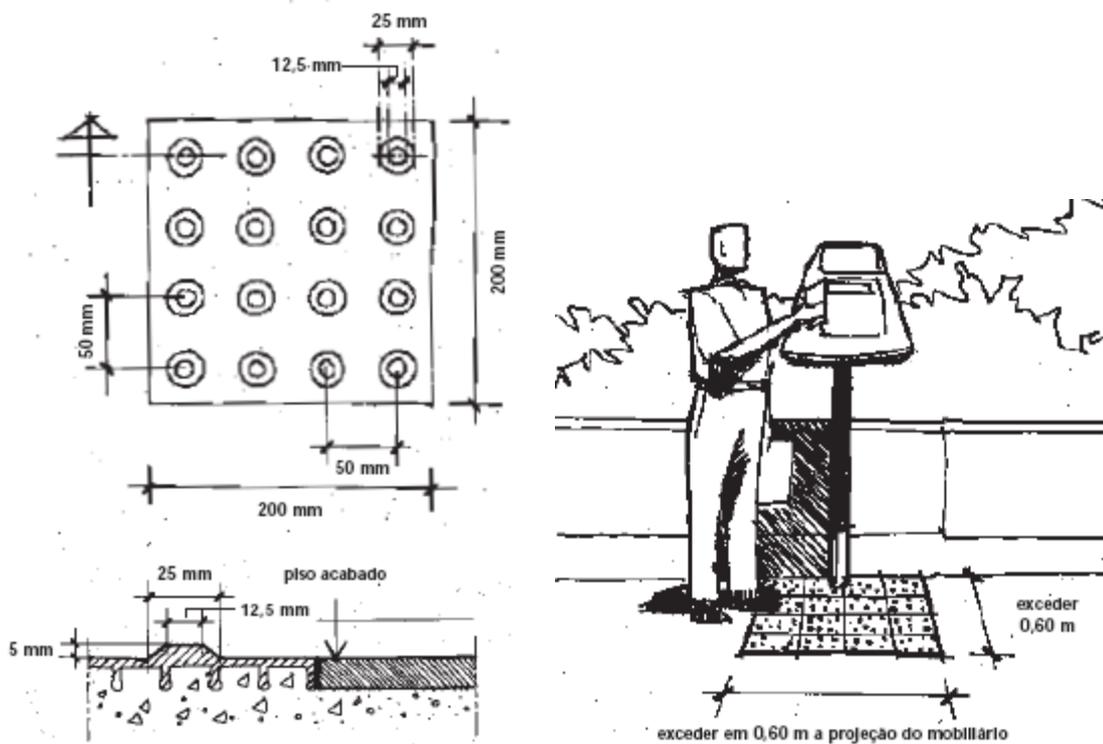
Especificação de piso tátil de alerta (sem escala) e exemplo de uso.
